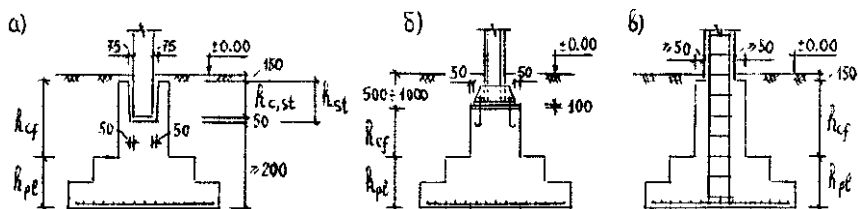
Конструктивные решения соединения колонн с отдельным фундаментом: а – сборной железобетонной, б – металлической, в – монолитной железобетонной
